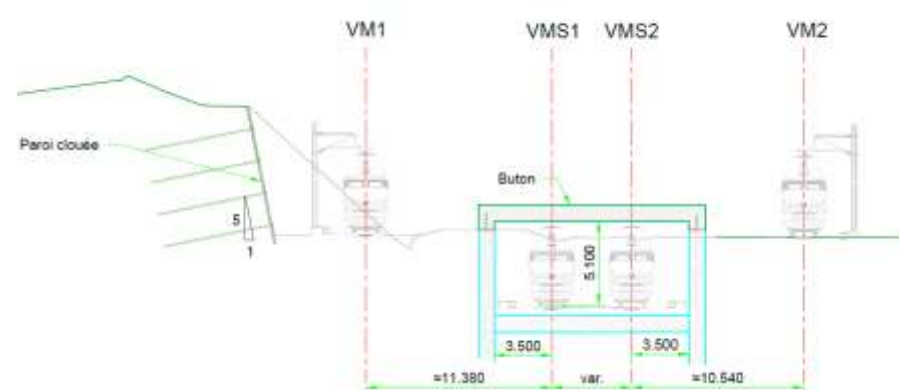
Profil en travers – tranchée ouverte (EGIS, 2021)
